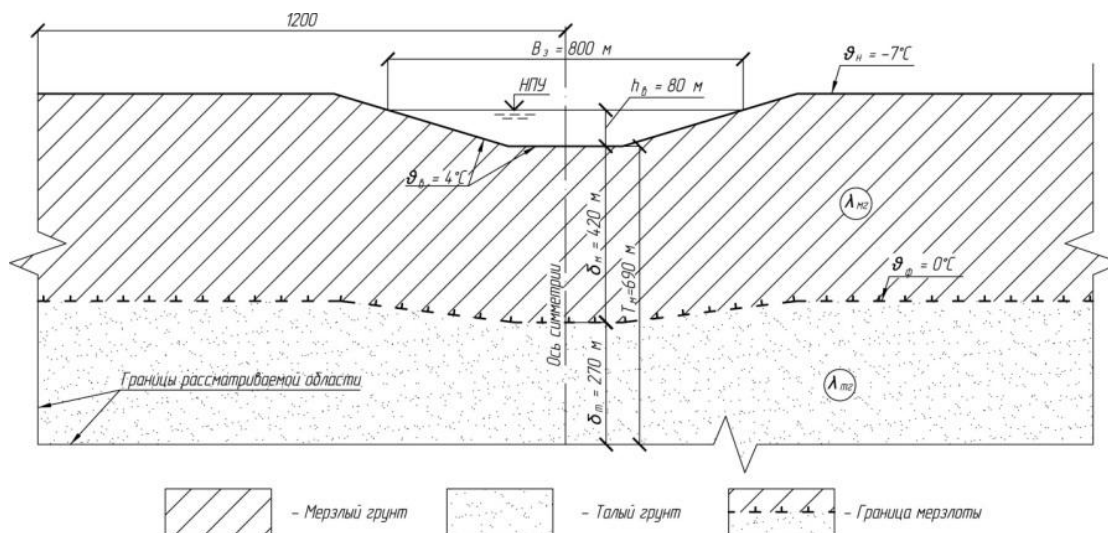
Расчетная схема ложа водохранилища в северной строительно-климатической зоне
